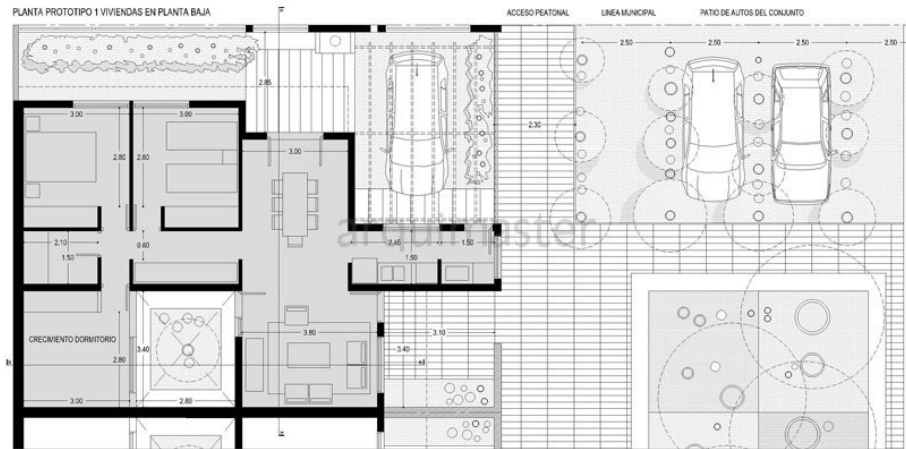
Plantas baixa protótipo 01, edificação térrea.
